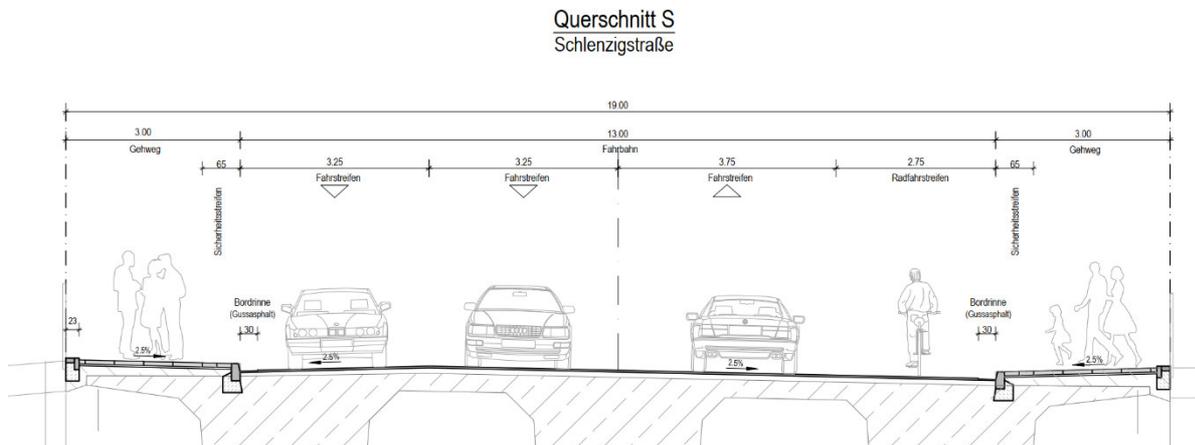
Querschnitt Schlenzigstraße (Brücke)
